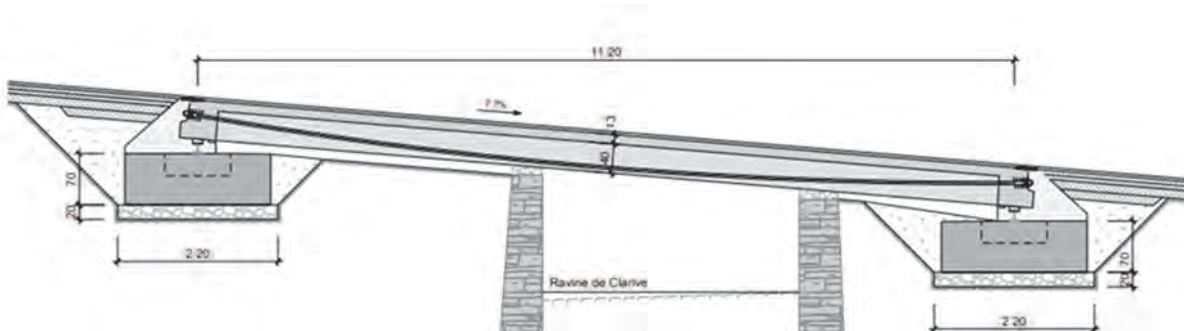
Coupe longitudinale du nouveau Pont de Clarive
